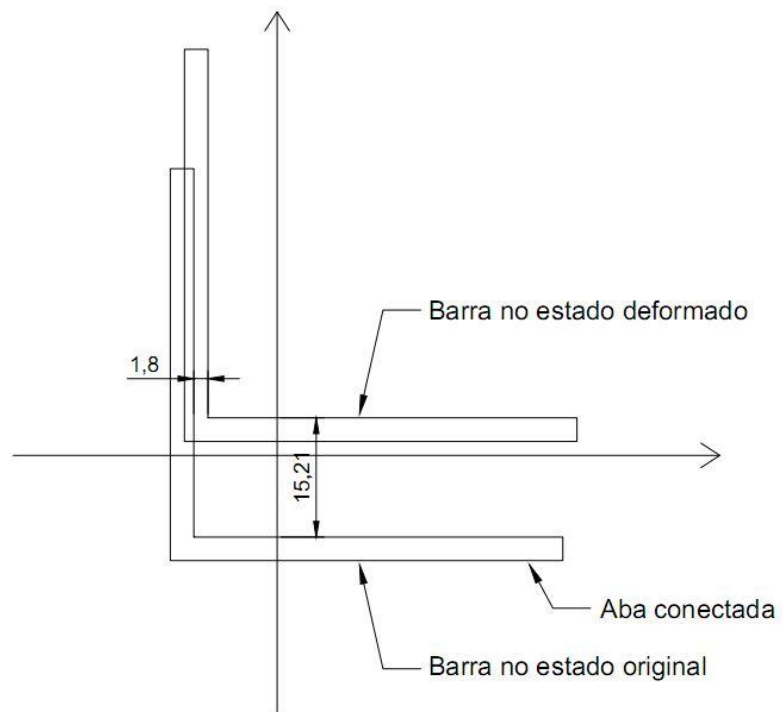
Cantoneira no estado original e estado deformado para esbelteza 100. Fonte: O autor.
